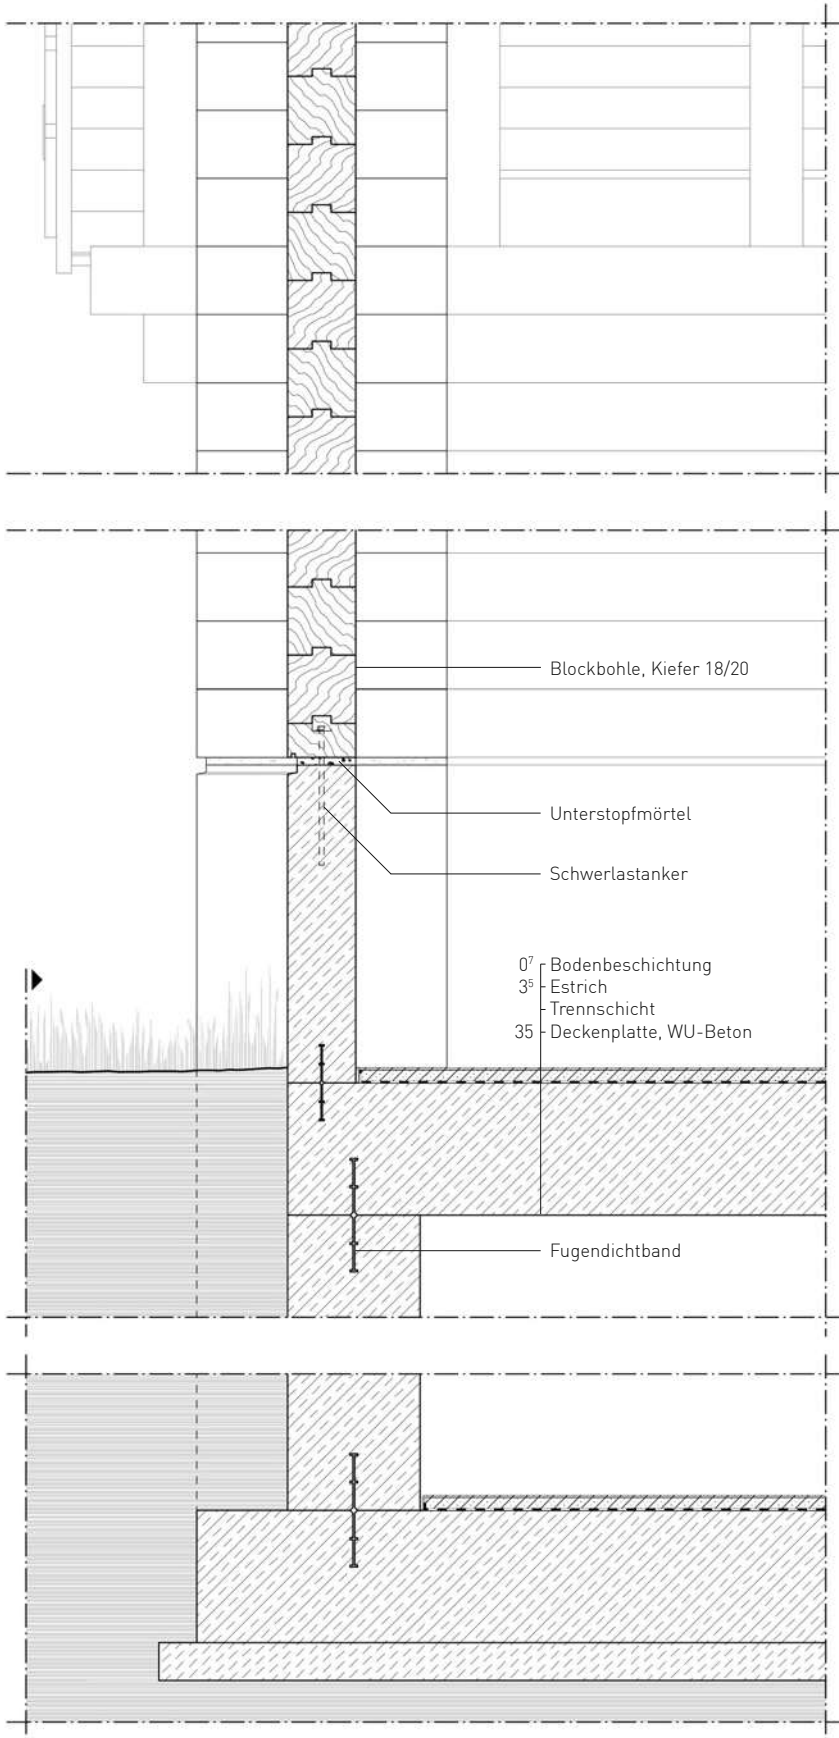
Detailschnitt Giebelwand 1:20
